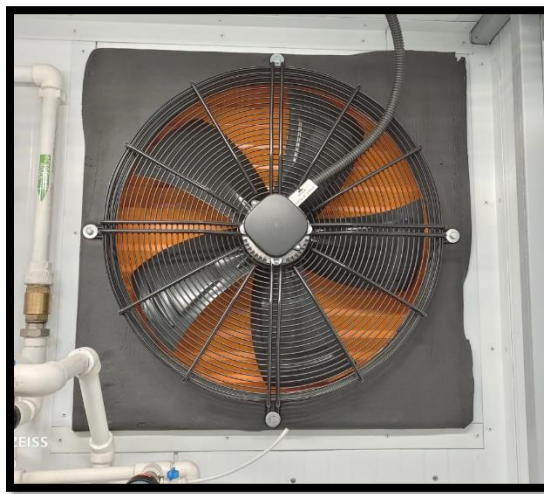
Внешний вид корпуса вытяжного вентилятора в отсеке индукторов
